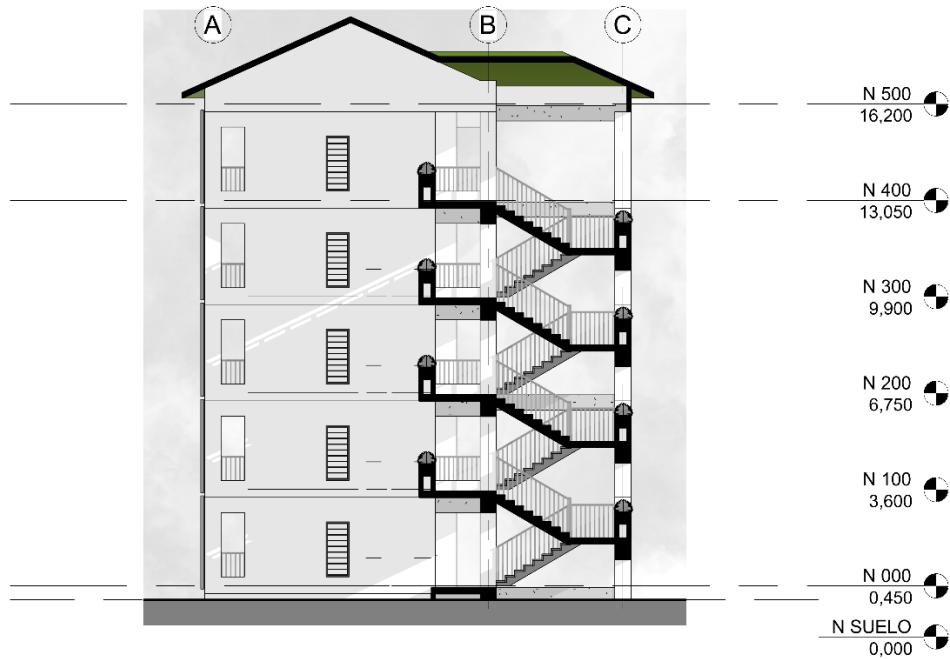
SECCIÓN TRANSVERSAL EDIFICIO 1 | Elaborado por: El autor
